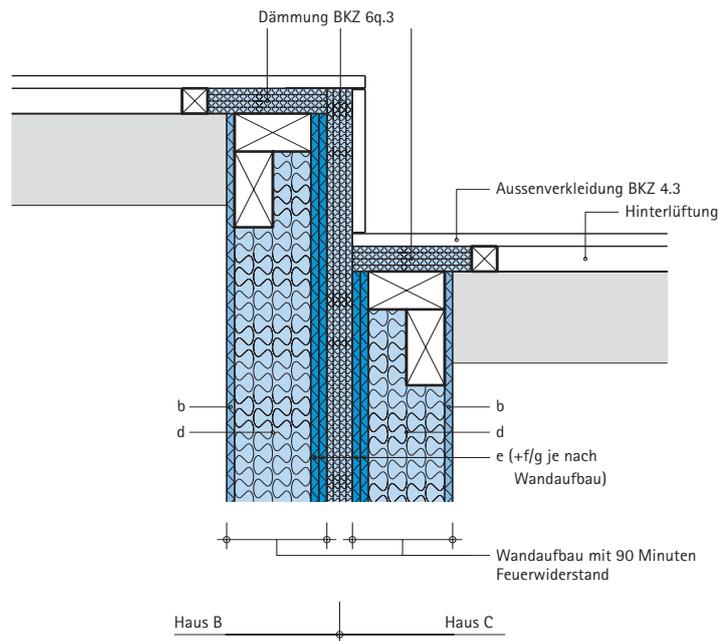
Fassadenanschluss mit versetzten Fassadenflächen und hinterlüfteter Aussenwandverkleidung
